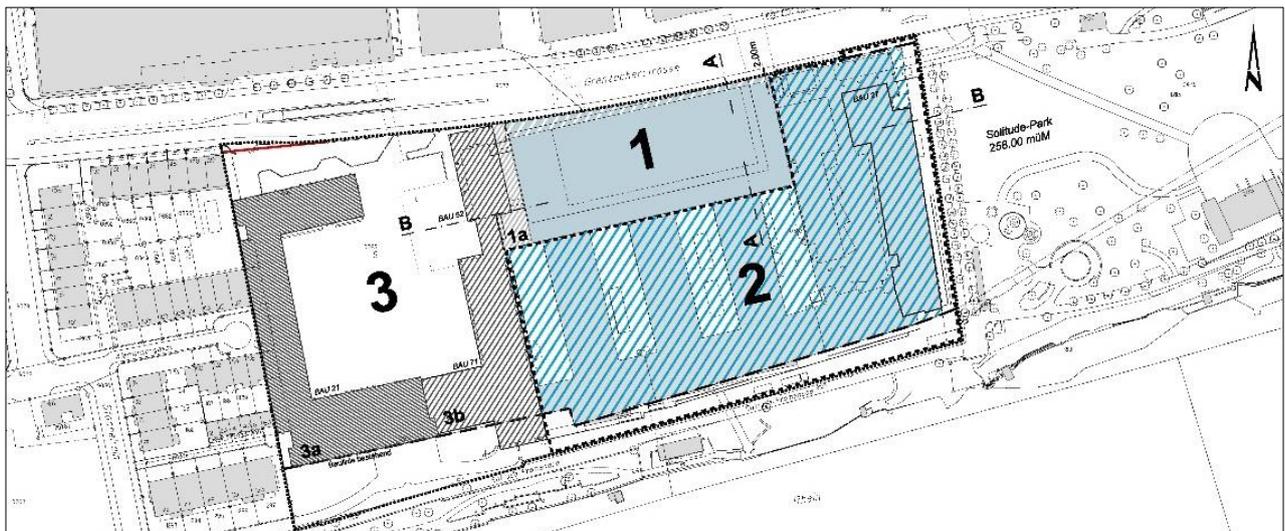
Bestehender Bebauungsplan Nr. 193. Situation (Kein Massstab, Plan genordet)
